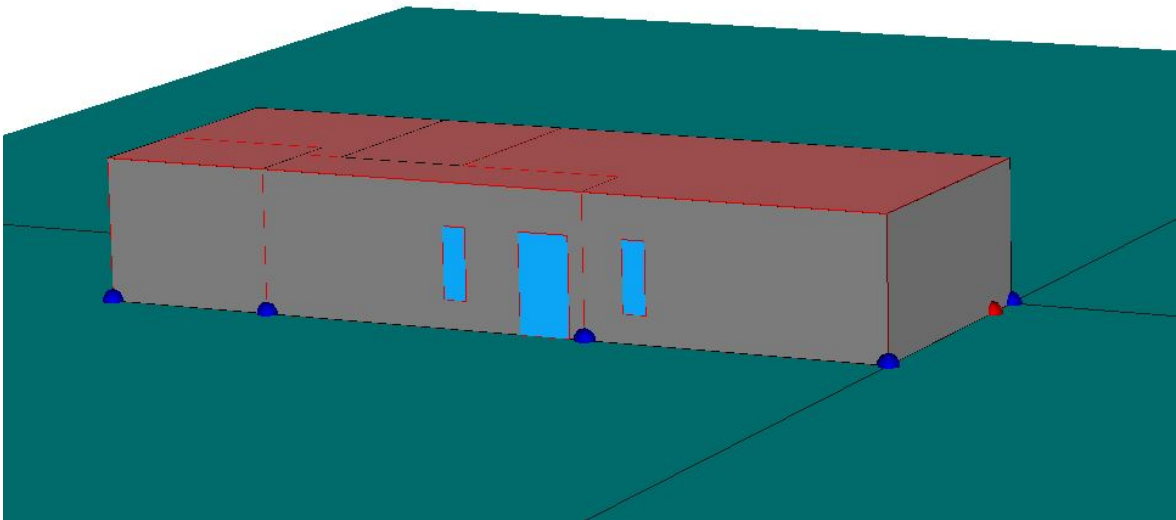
Modelado de la vivienda en HULC (vista fachadas norte y oeste)
